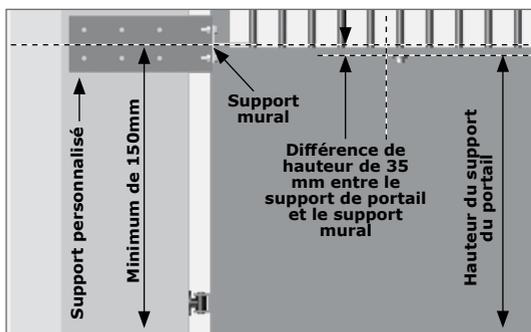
HAUTEUR DU SUPPORT MURAL
